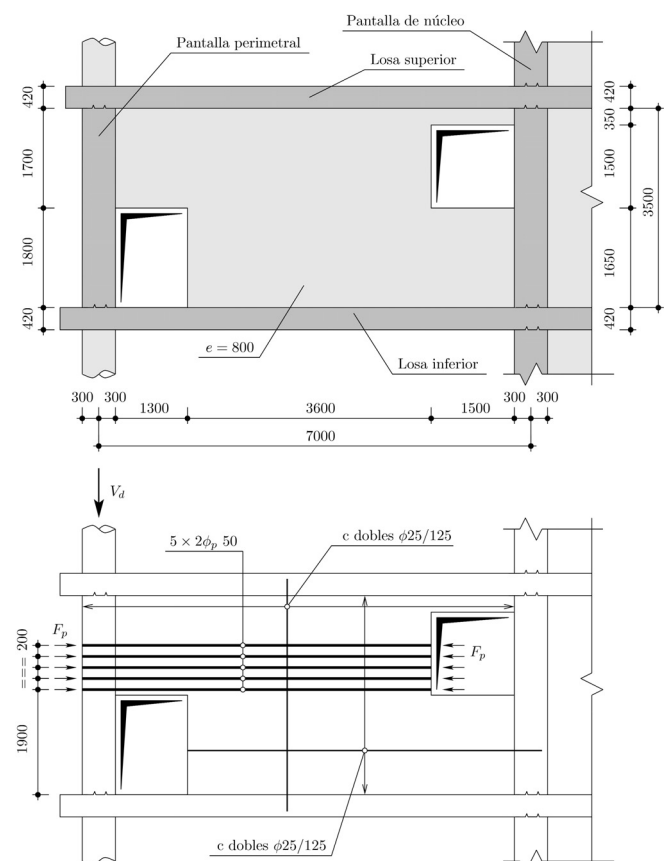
Geometría y esquema de armado y de acciones sobre la viga cargadero (cotas en mm).
